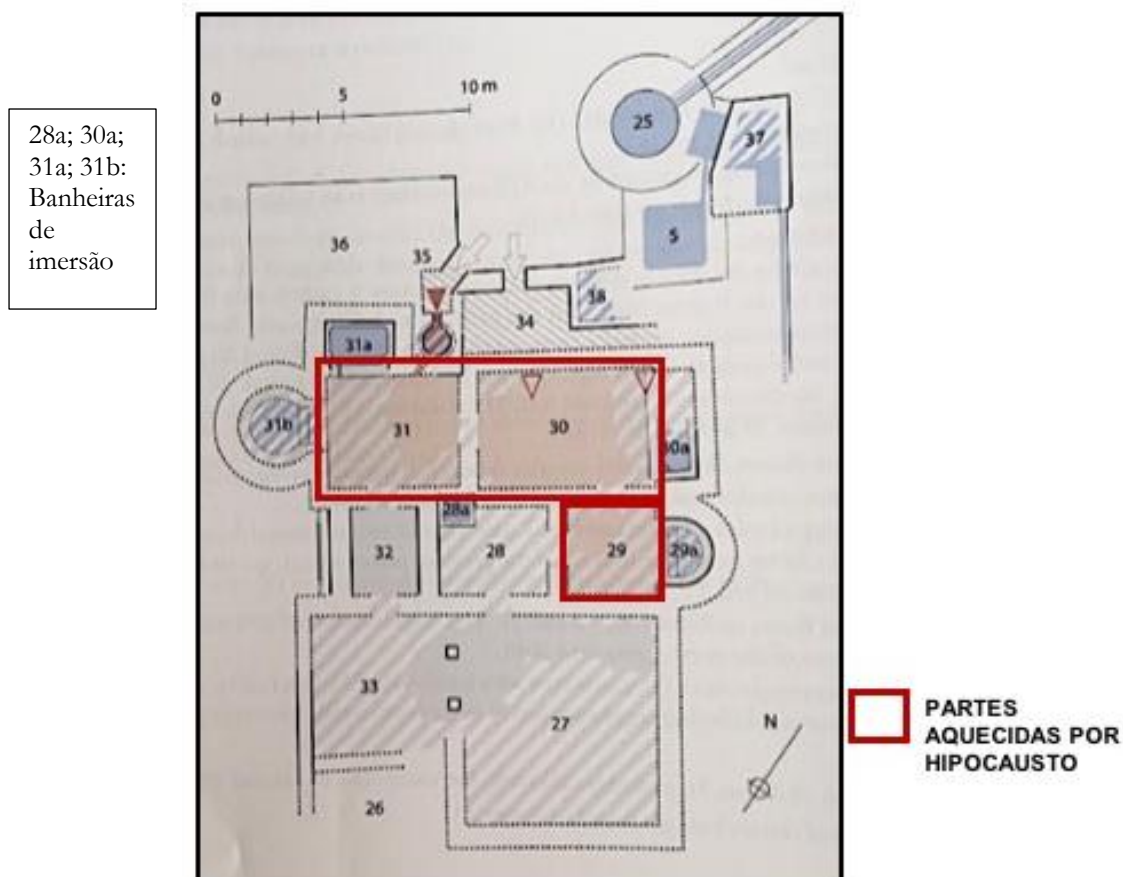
Butô – Banho Norte - planta do 3º estágio de ocupação. Fonte: REDON, 2017: 466.
